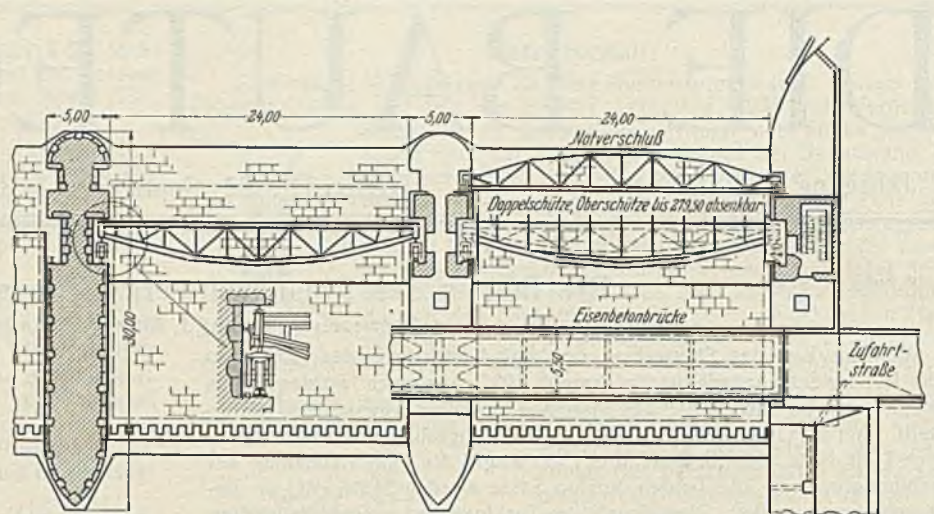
Stauwehr. Grundschnitte und Draufsicht.
